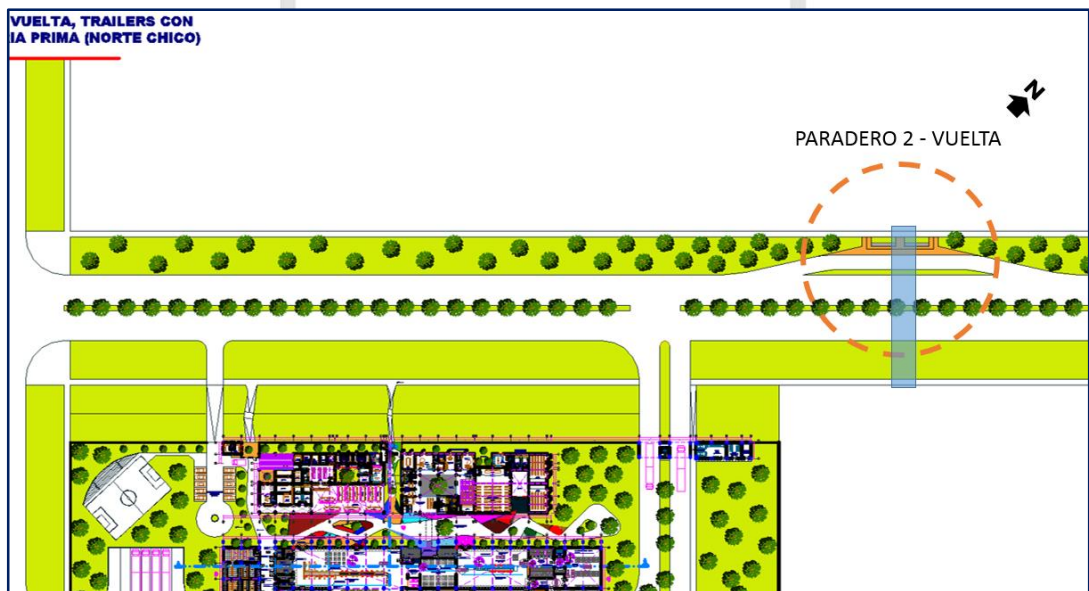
Imagen paradero N° 2 Fuente: Propia
